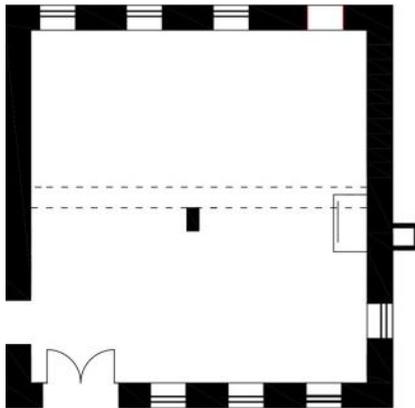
Grundriss Werkstätte Schlosserei
